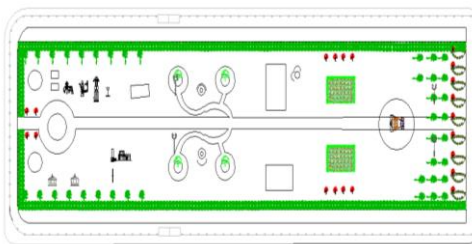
Lokasi Ruang Terbuka Hijau Nglangon Ex Jokotingkir
